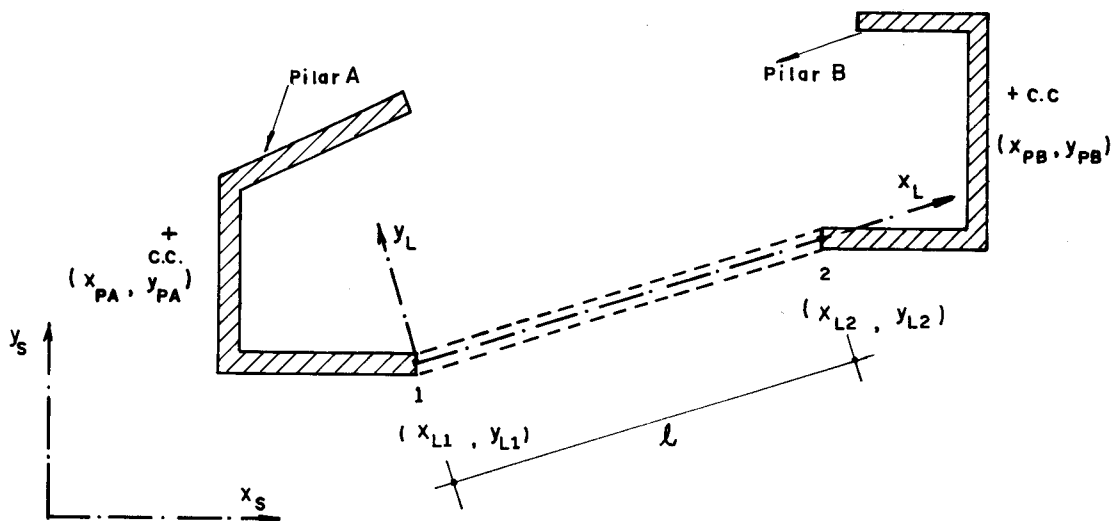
CONTRAVENTAMENTO DE DOIS PILARES POR LINTÉIS
